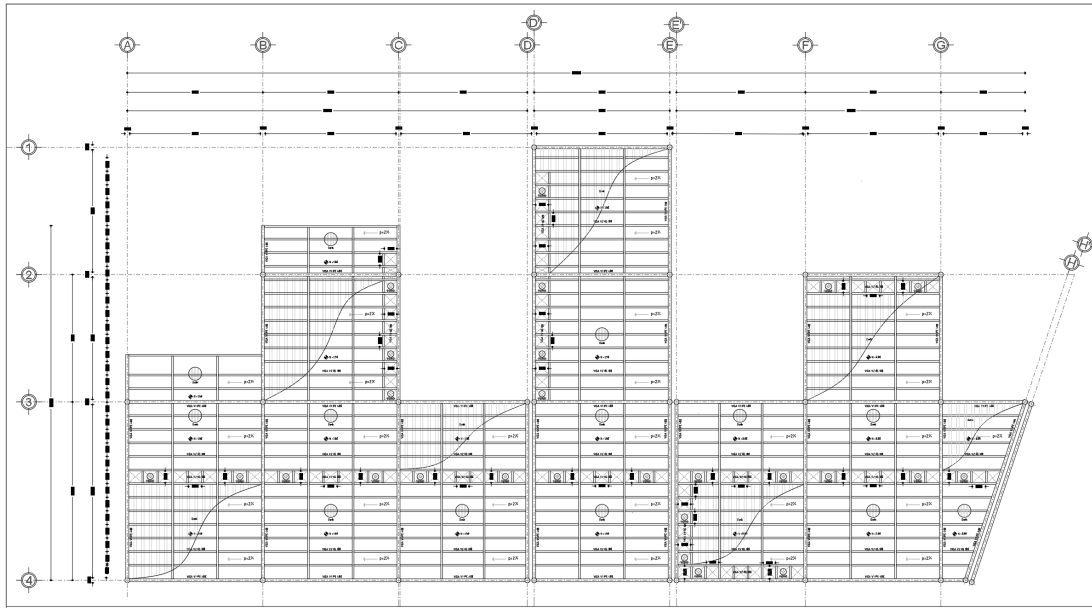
Planta de vigas. Elaboración: (Pérez, 2018)
